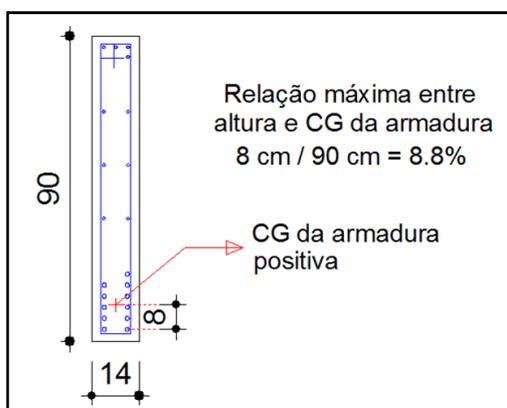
RELAÇÃO ENTRE CENTRO DE GRAVIDADE DA ARMADURA E ALTURA DA VIGA.
